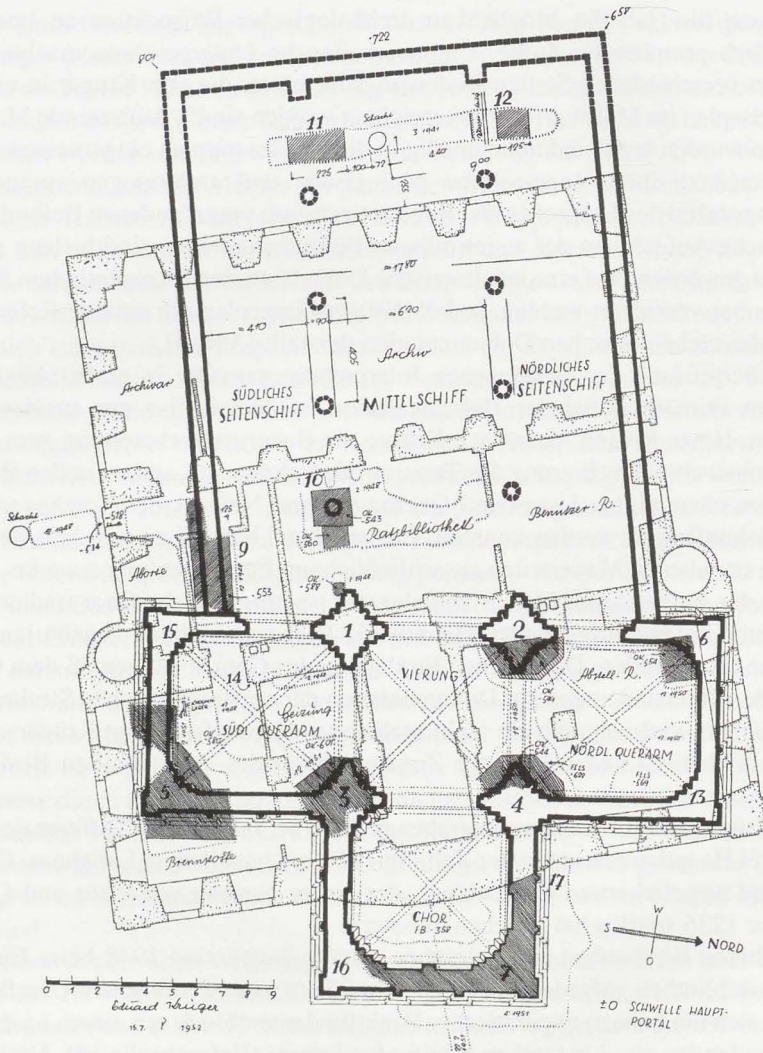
Überlagerung des Rathausgrundrisses mit den ergrabenen und ergänzten Mauerteilen von St. Jakob nach der durch Eduard Krüger publizierte Planfassung.
